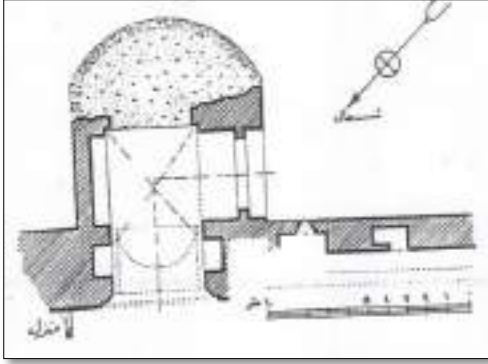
تمثل برج (١٣، ١٤) مسقط أفقي للباب المحروق^٣
